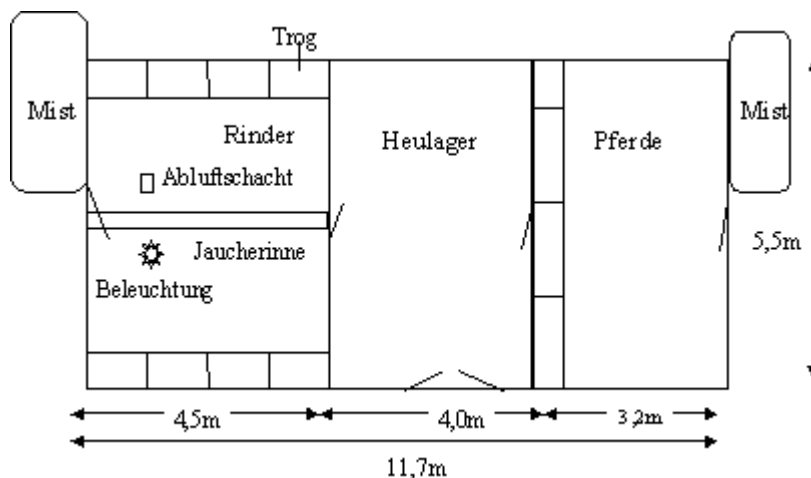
Grundriss eines 3-teiligen Rinder-/Pferdestalls
